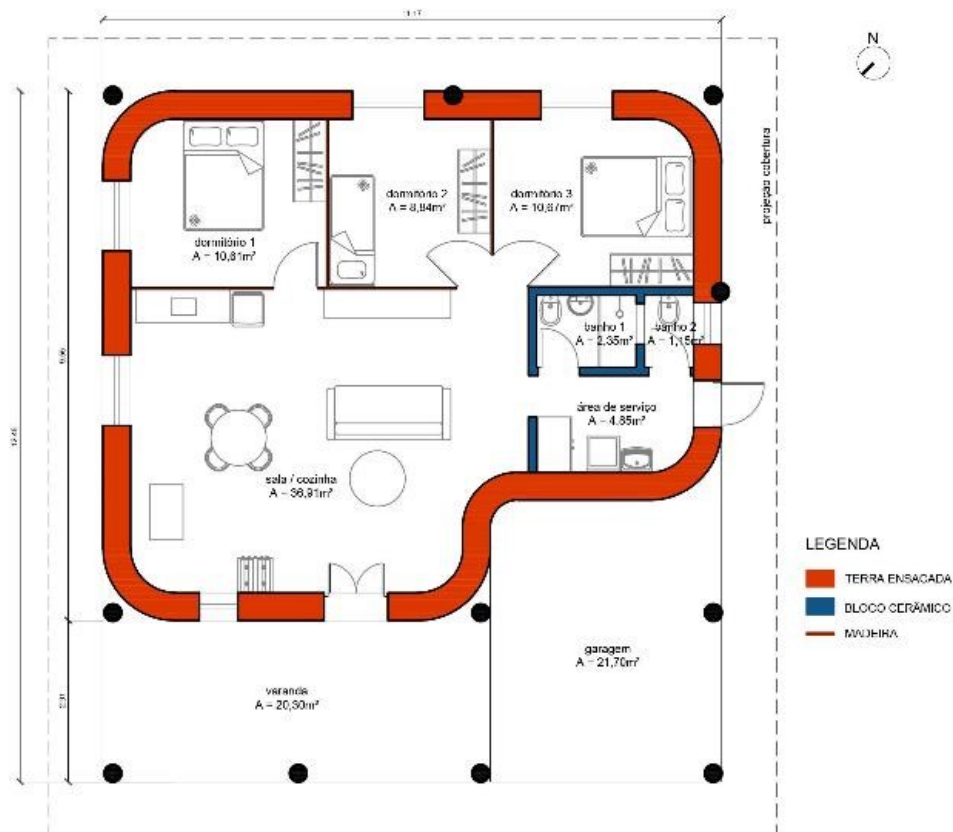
Planta baixa Edificação 05. Fonte: Autora
